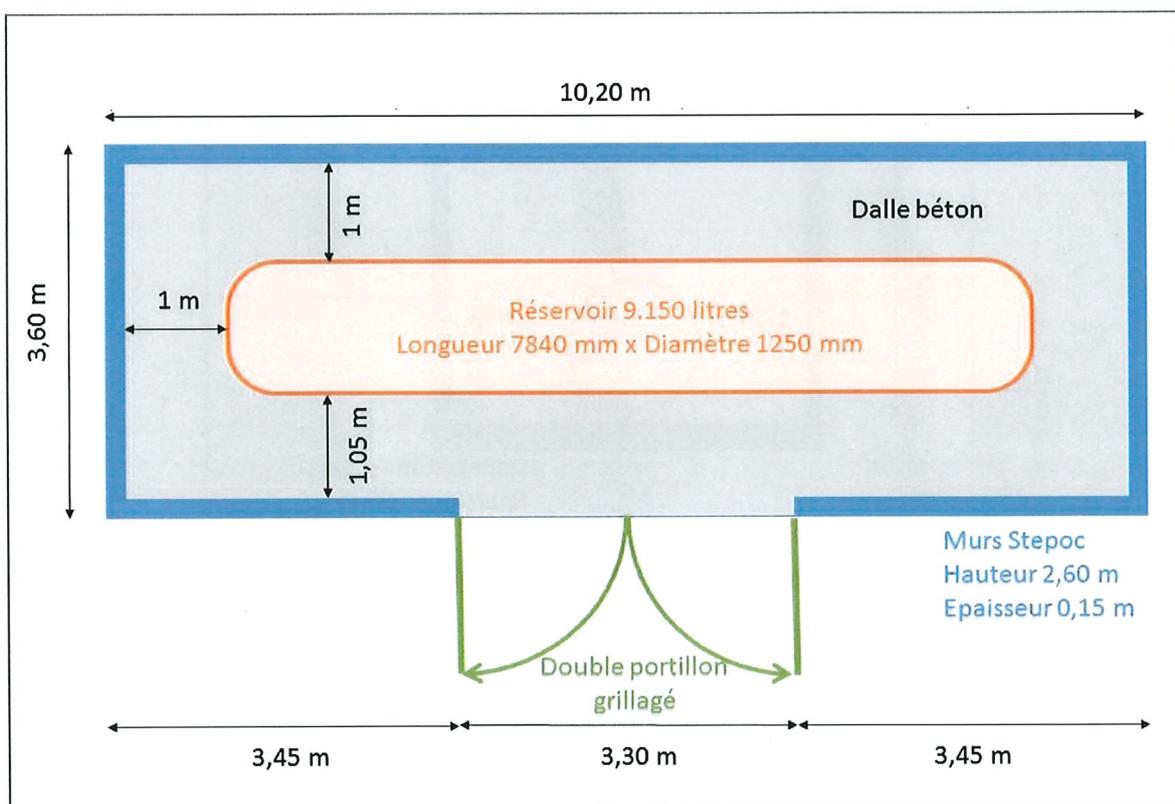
Vue en plan de l'implantation de la citerne DS009.
